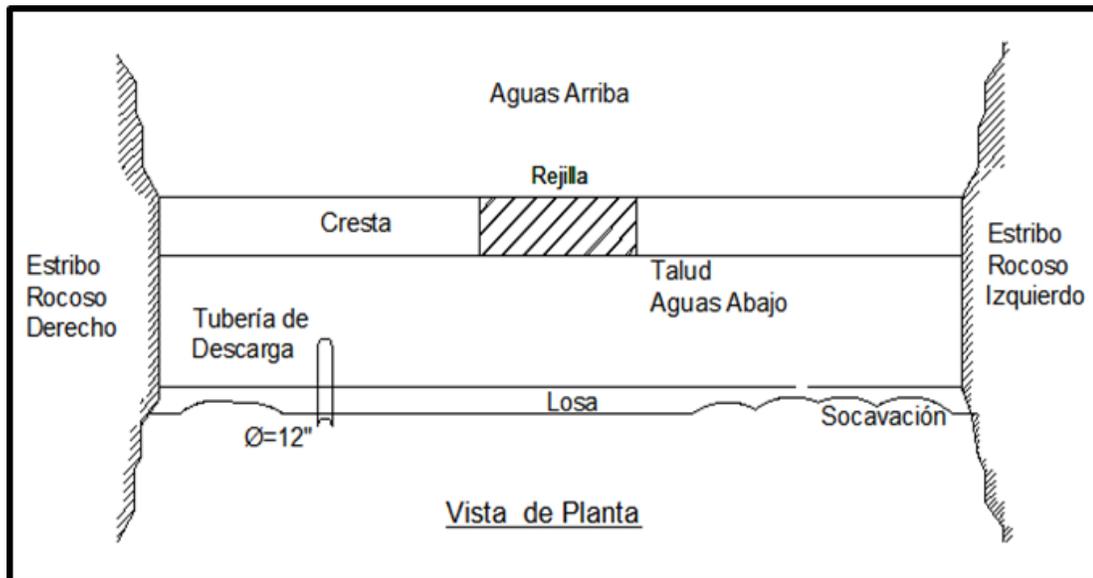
Vista en planta del dique de concreto (Hernández, 2022).
